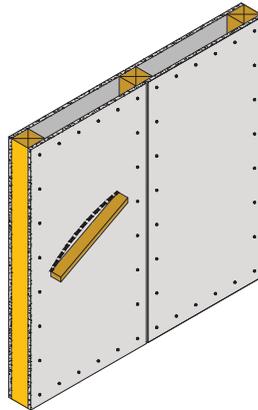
Tolerancia para planeidad de tabiques revestidos con placas o planchas (Fuente: CDT, 2013).
